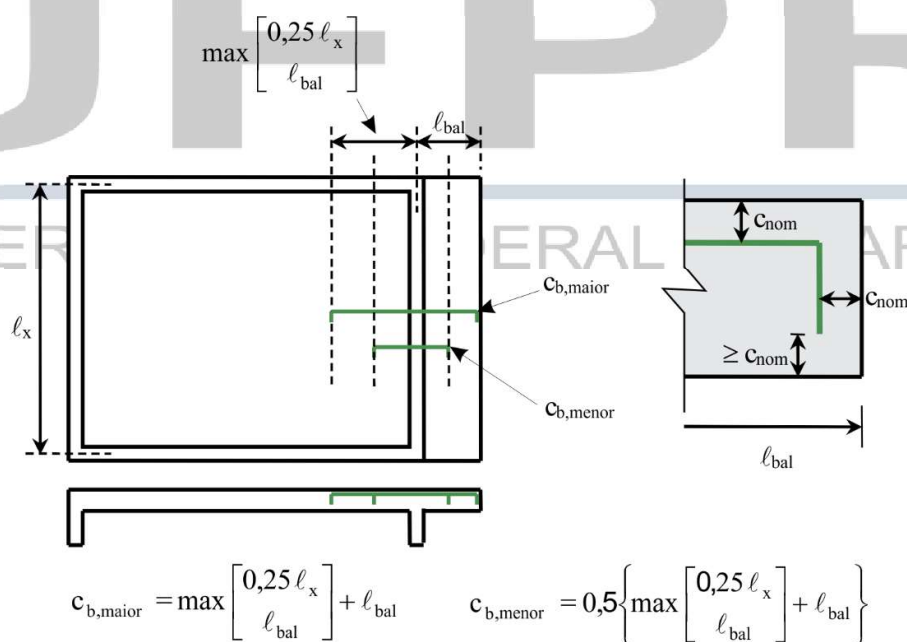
Comprimento de barras não alternadas de lajes em balanço – armadura negativa
